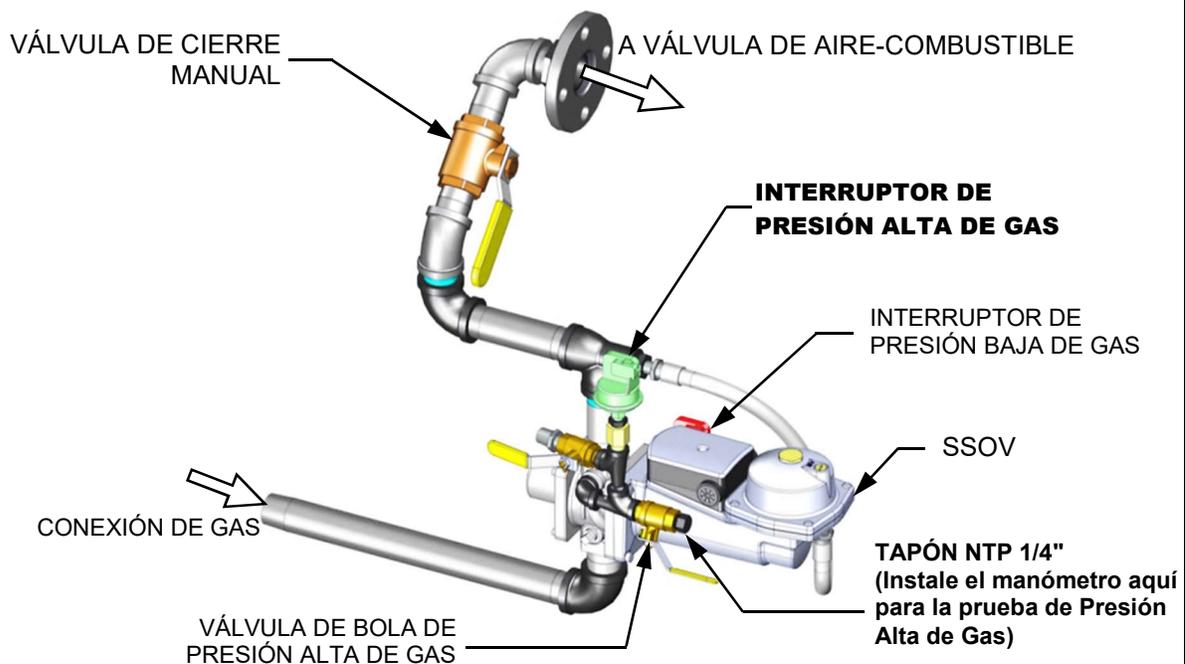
Componentes de prueba de presión ALTA de gas de BMK 750/1000
